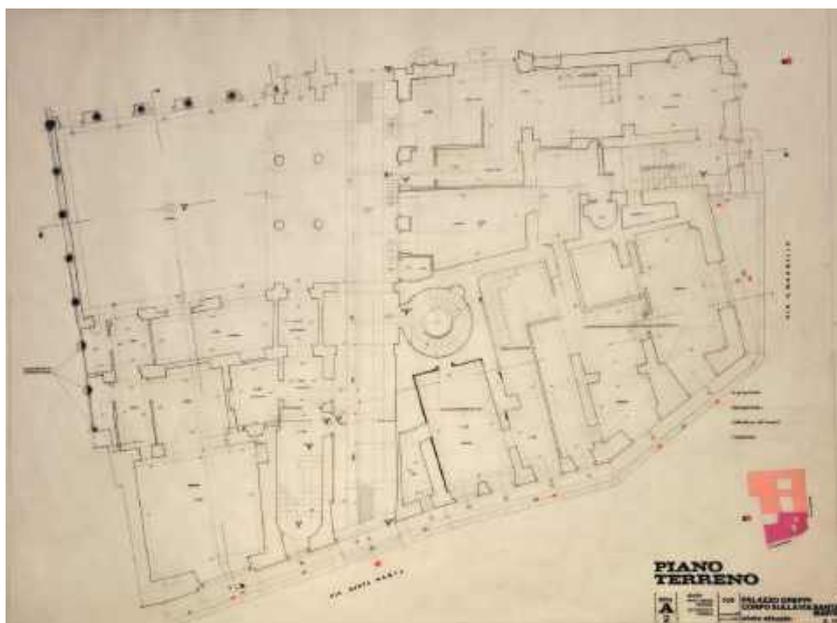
Corpo su via Santa Marta, pianta piano terreno, rilievo stato di fatto; tavola su lucido
